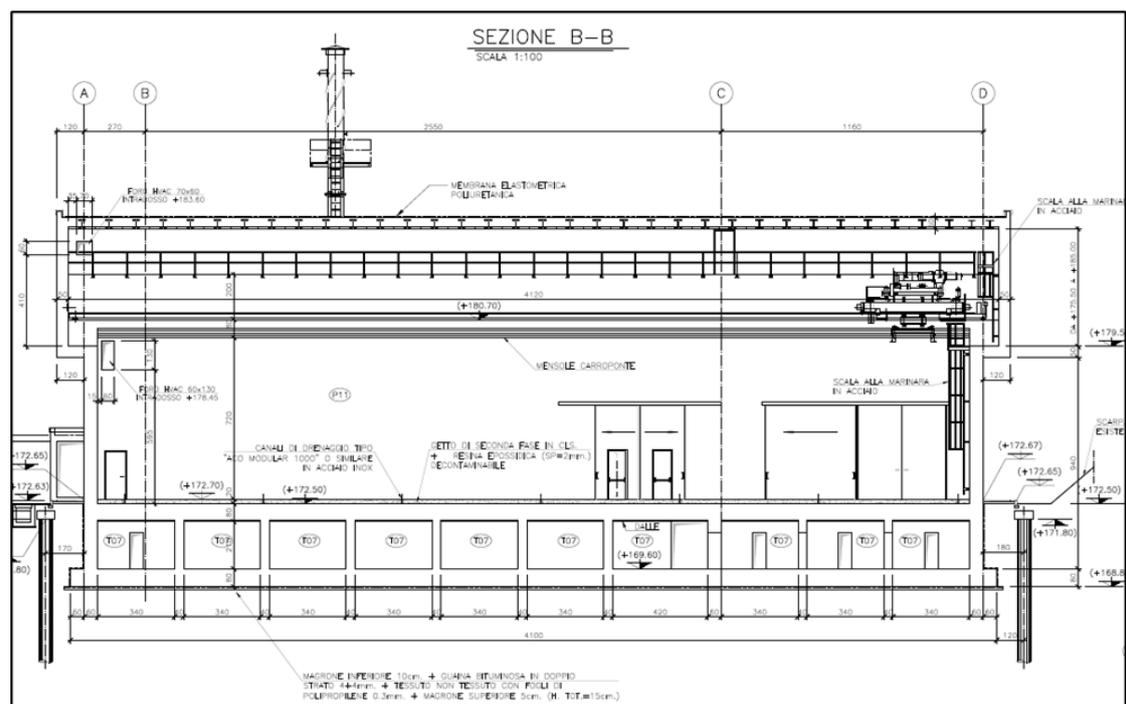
Nuovo deposito 2300: sezione tipica longitudinale
